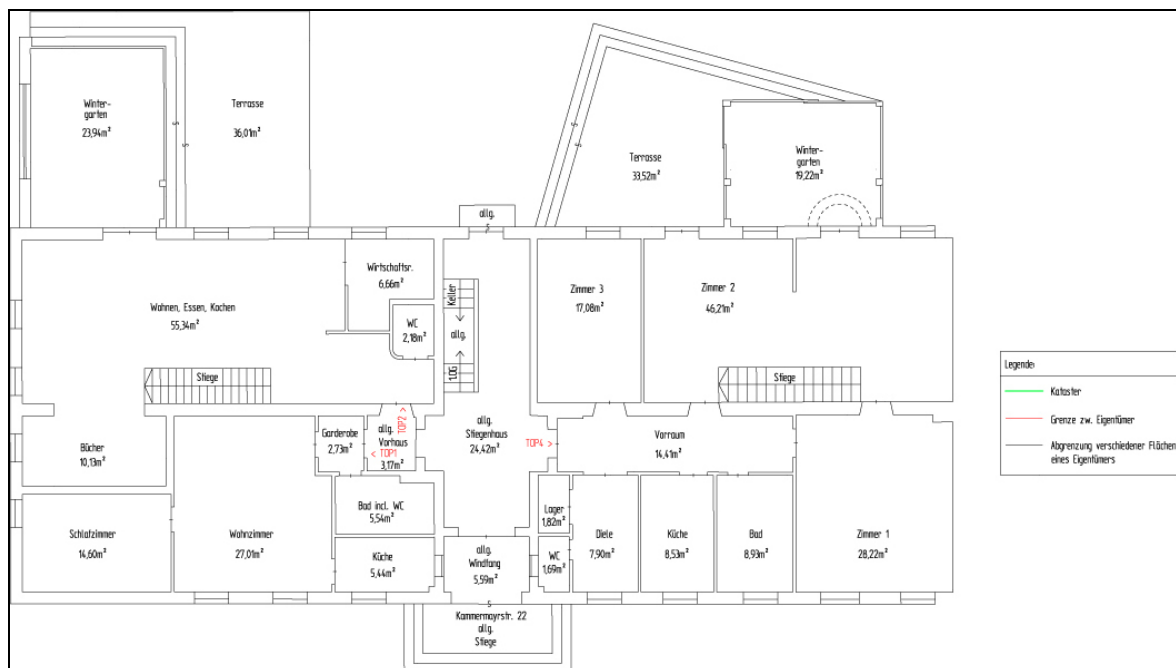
Parifizierungsplan Erdgeschoß Haus Kammermayrstraße 22 [Vermessungsbüro DI Mayrhofer]
